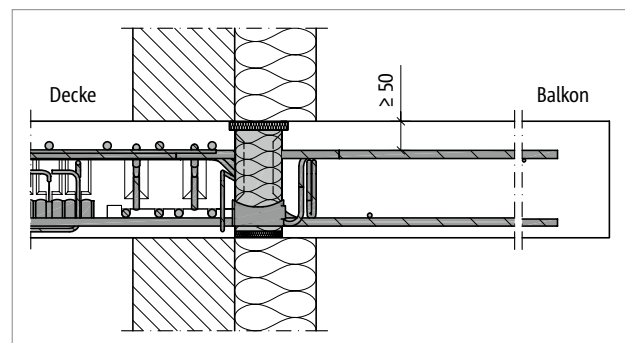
Schöck Isokorb® T Typ C: Schnitt 2. Lage; Anschluss bei Wärmedämmverbundsystem (WDVS)
